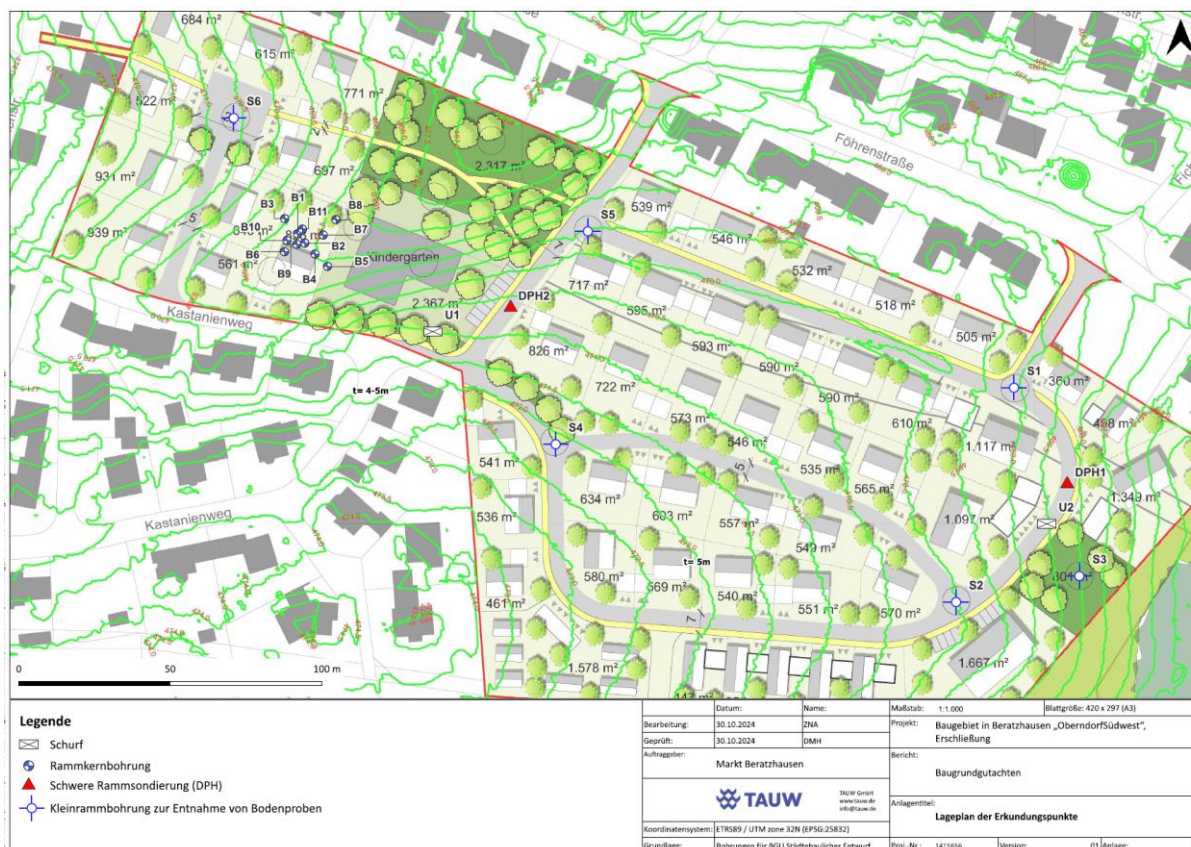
Auszug aus dem Baugrundgutachten der Fa. TAUW GmbH, Lageplan der Erkundungspunkte. Westlich des geplanten Kindergartens befindet sich in der linken Bildhälfte der potenzielle Dolinenbereich mit Eintragung der Bohrpunkte B1-B11.
